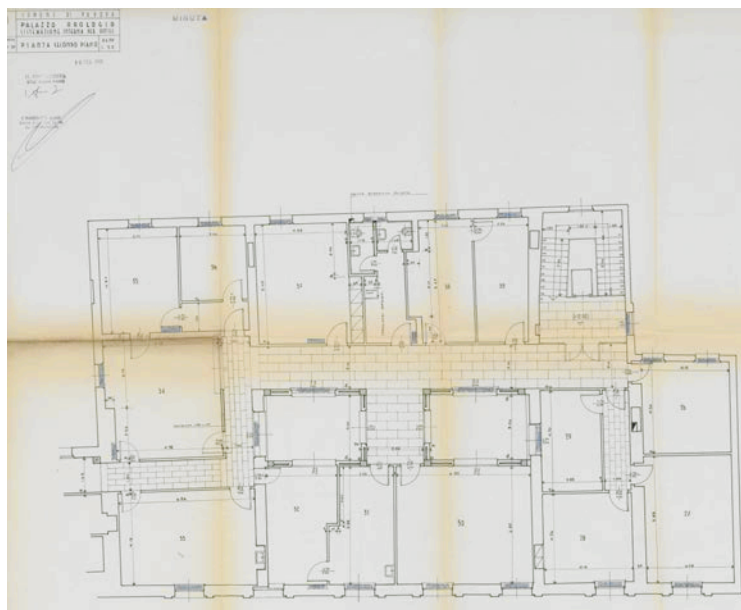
Estratto pianta piano secondo (1960) - (Archivio del Comune di Padova)
